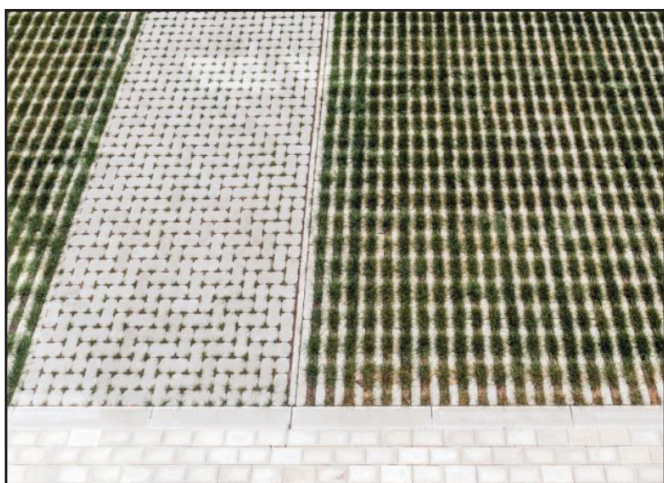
Dalles gazon. Sources : Ebema Stone & Style
